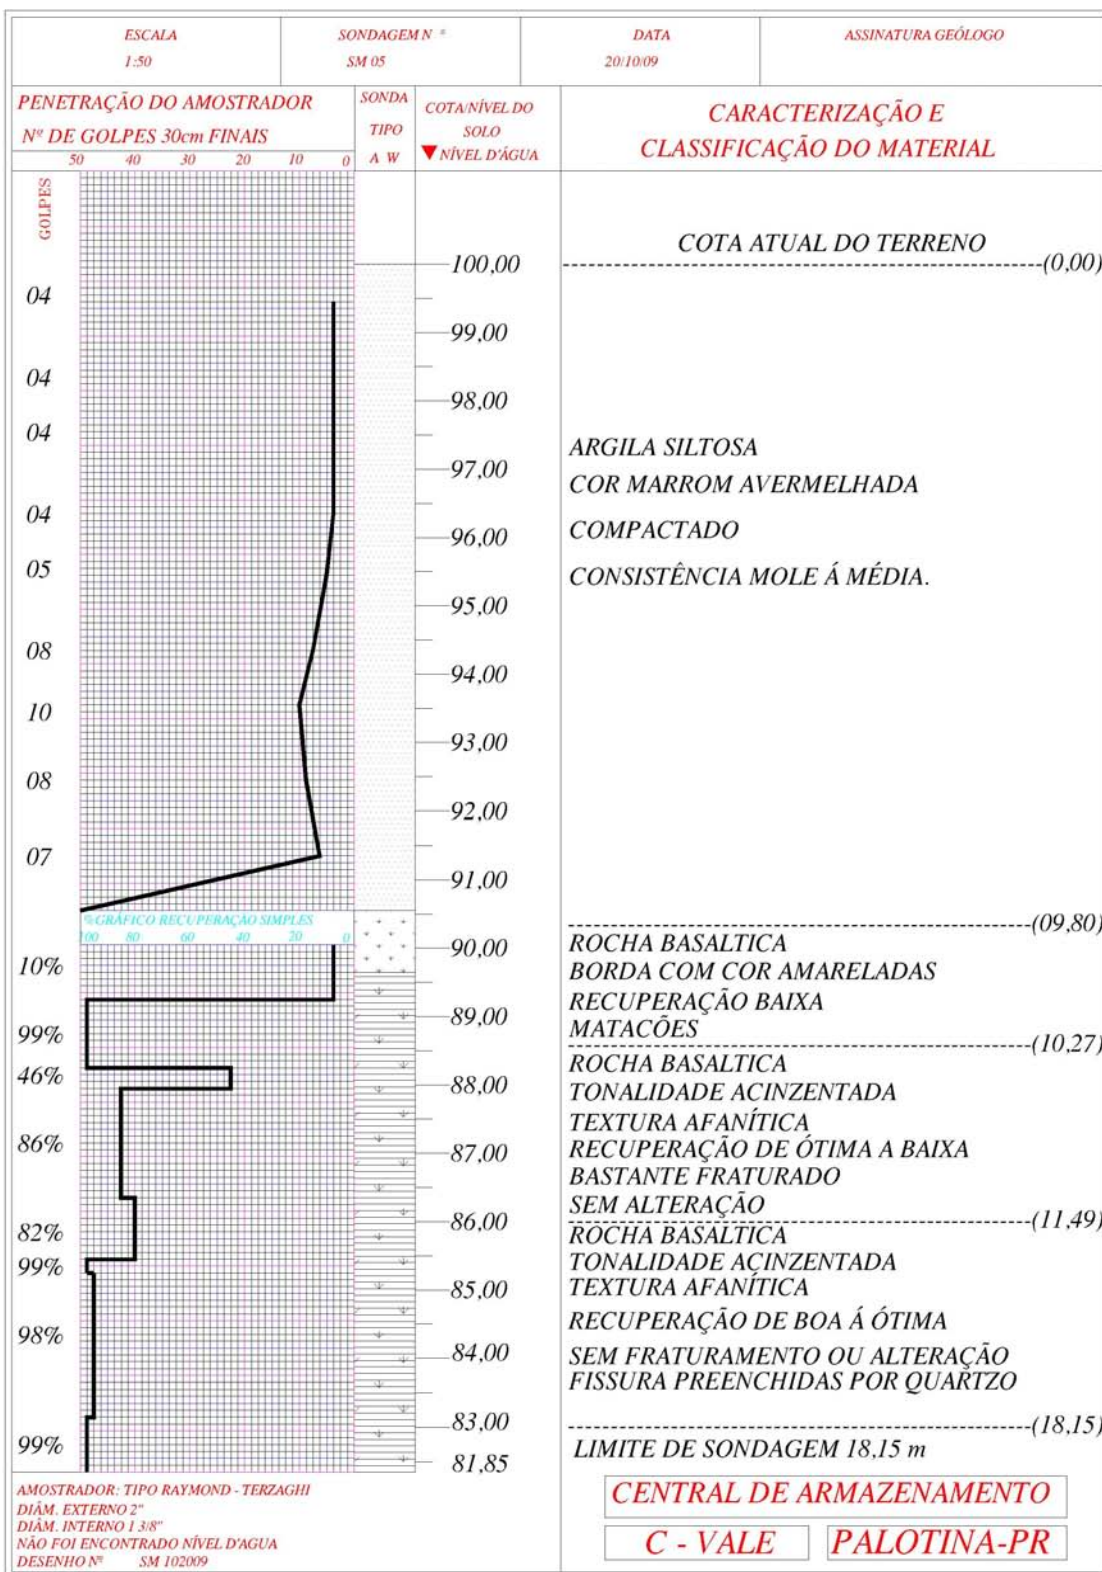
Perfil Sondagem Mista (SM) furo 05.
